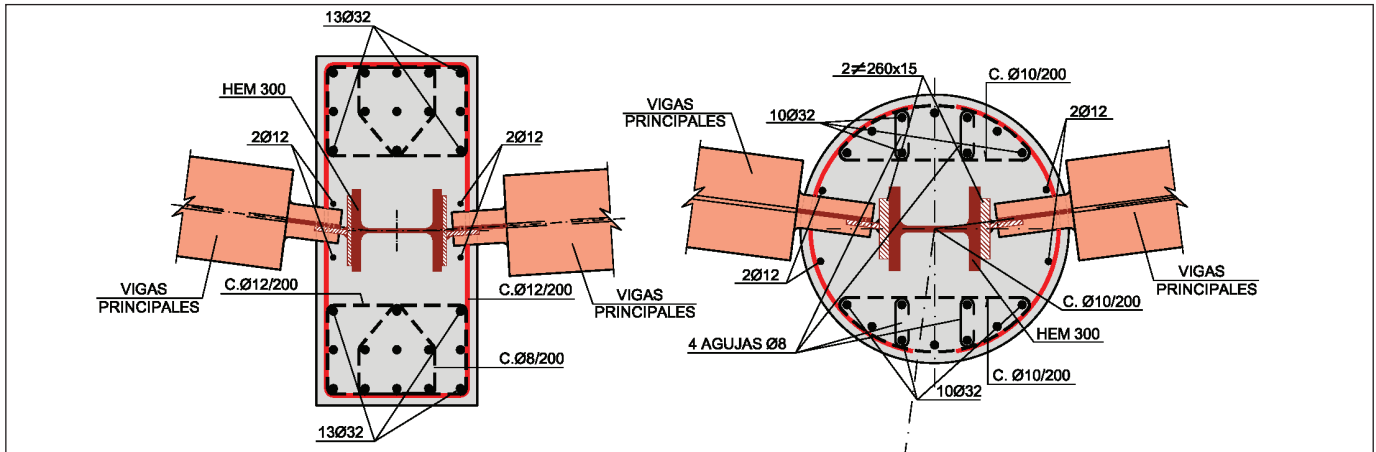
Secciones tipo de los soportes mostrando el perfil metálico auxiliar empleado para facilitar el montaje de la estructura metálica.
